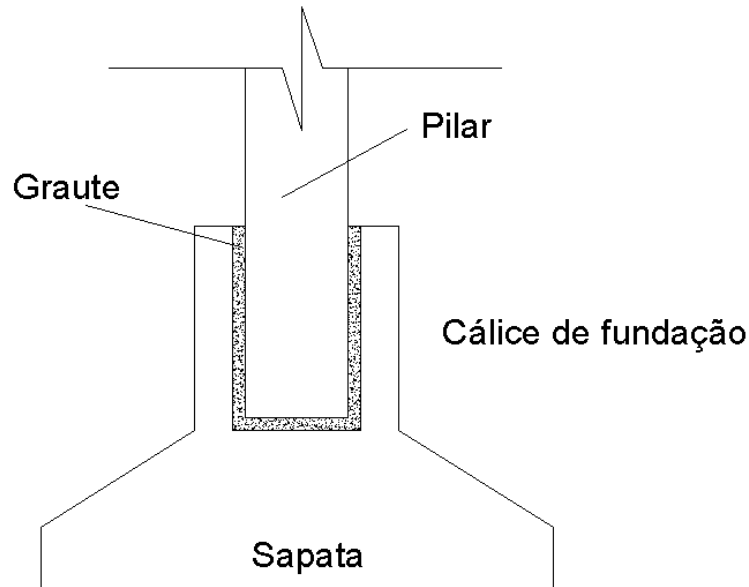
Ligação pilar-sapata, por cálice de fundação.
